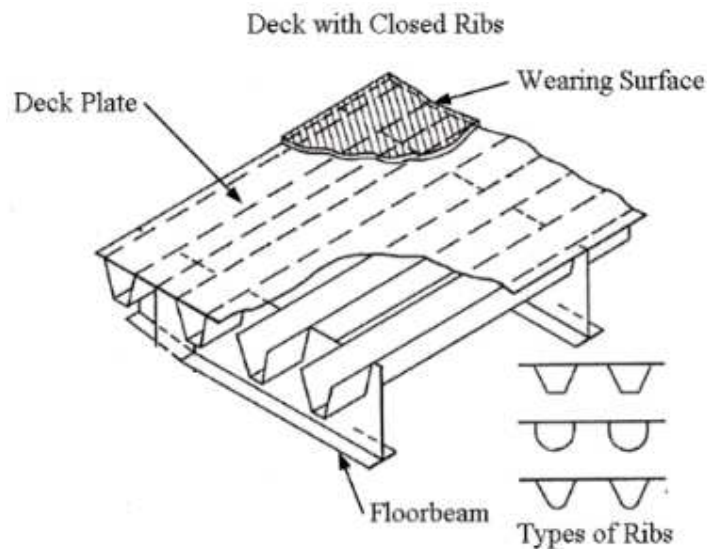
Vista placa Orto trópica utilizada en cubiertas de barcos, AISC (1963), Design Manual for Orthotropic Steel Plate Deck Bridges, American Institute of Steel Construction. Chicago, IL
